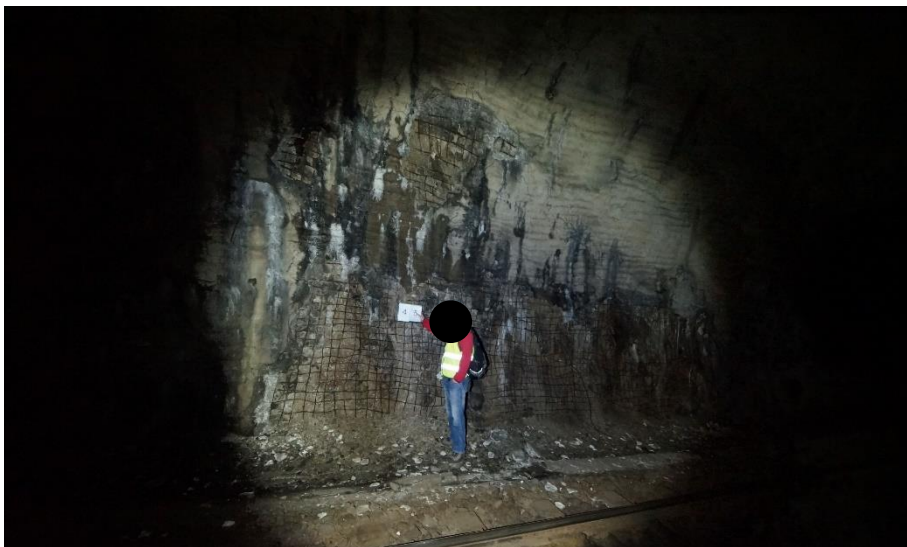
Polubenský tunel, stříkaný beton bez výztuže
